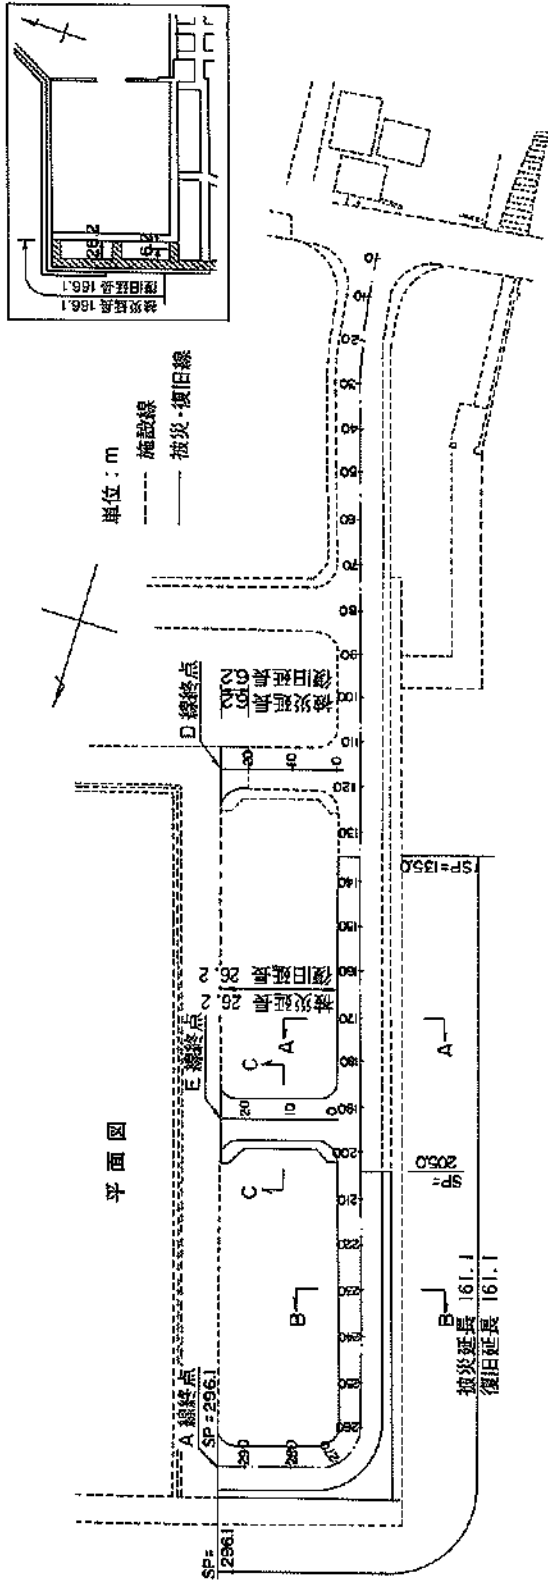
平面図・標準断面図 (②西臨港道路)
